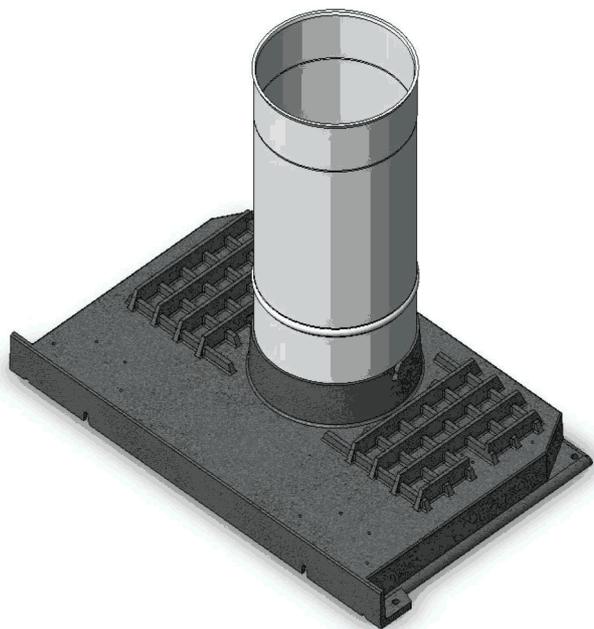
Exemple de jonction du conduit de raccordement dans le manchon (femelle)
